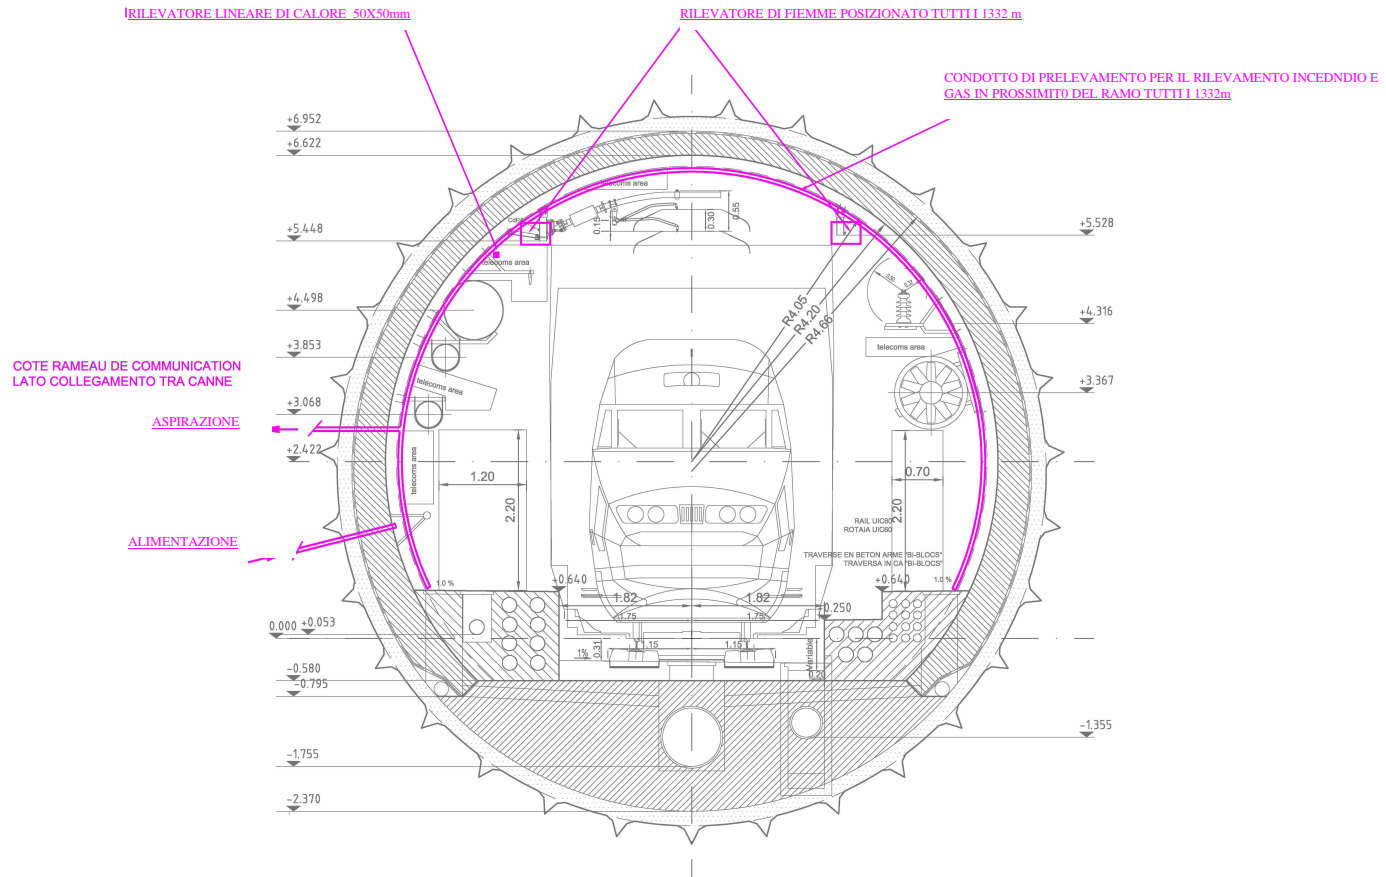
Spaccato tipo in tunnel per il rilevamento incendio e gas
